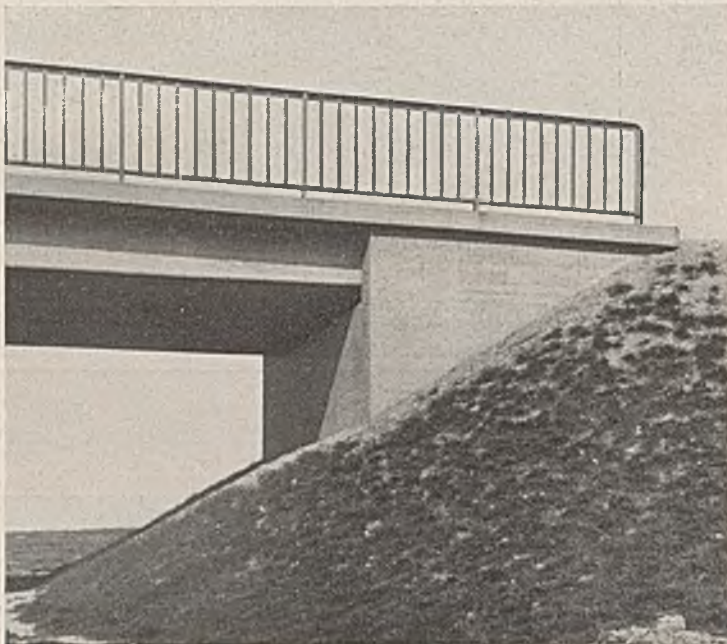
Brücke mit Eisenbetonbalkenträger, der versteckt gelagert ist, und mit Widerlagern mit Parallelfügeln.
